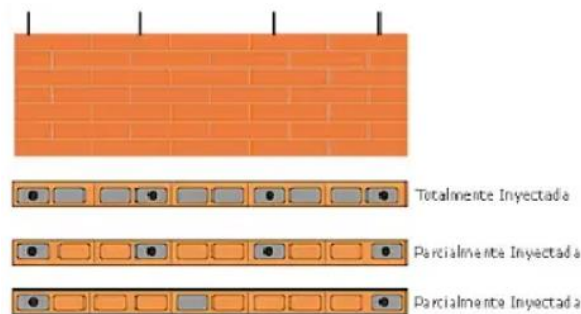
Mampostería parcialmente reforzada (<http://blogguernuevo.blogspot.com/>, 2016)
